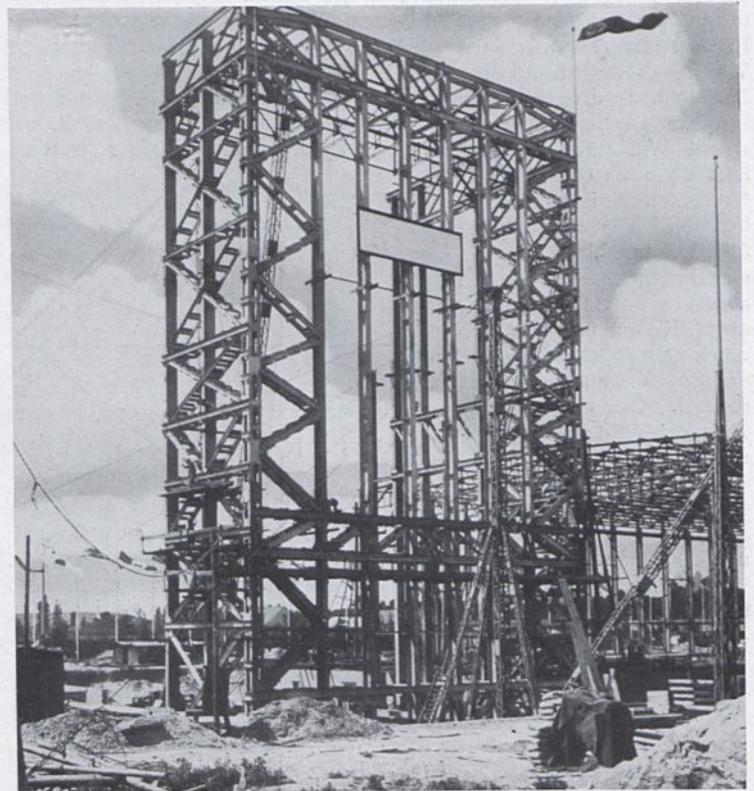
Frontwandrahmen und Dachbinder der Ehrenhalle mit Zwischenstützen.
